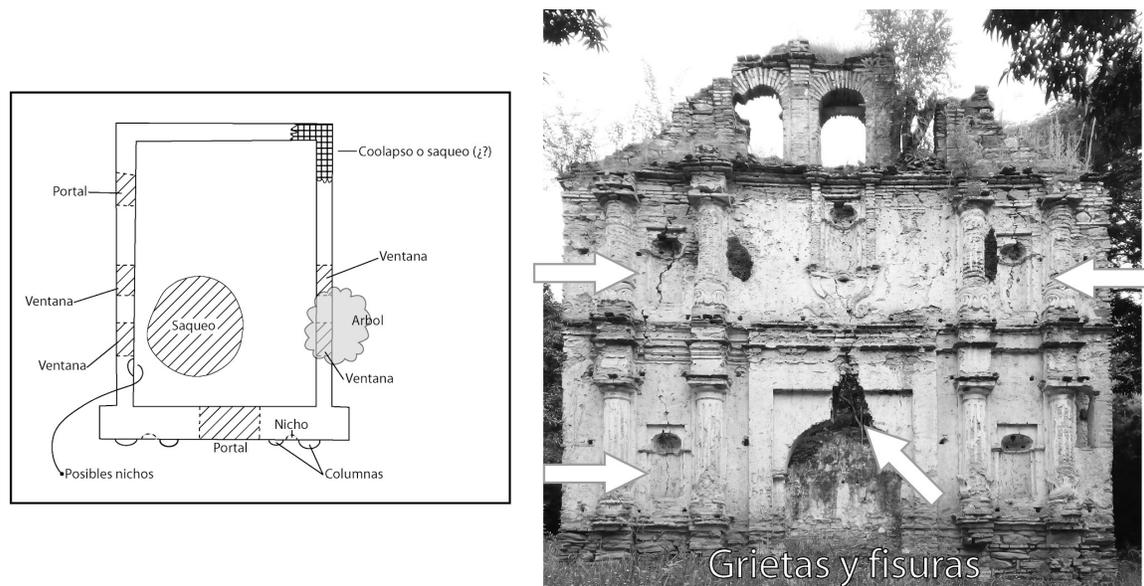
Croquis en planta de la estructura documentando saqueos (izquierda), así como grietas y fisuras en la fachada de la edificación (foto de la derecha). Fotografía de M. Álvarez, dibujo del croquis, vectorización y arreglo por O. Schwendener.
